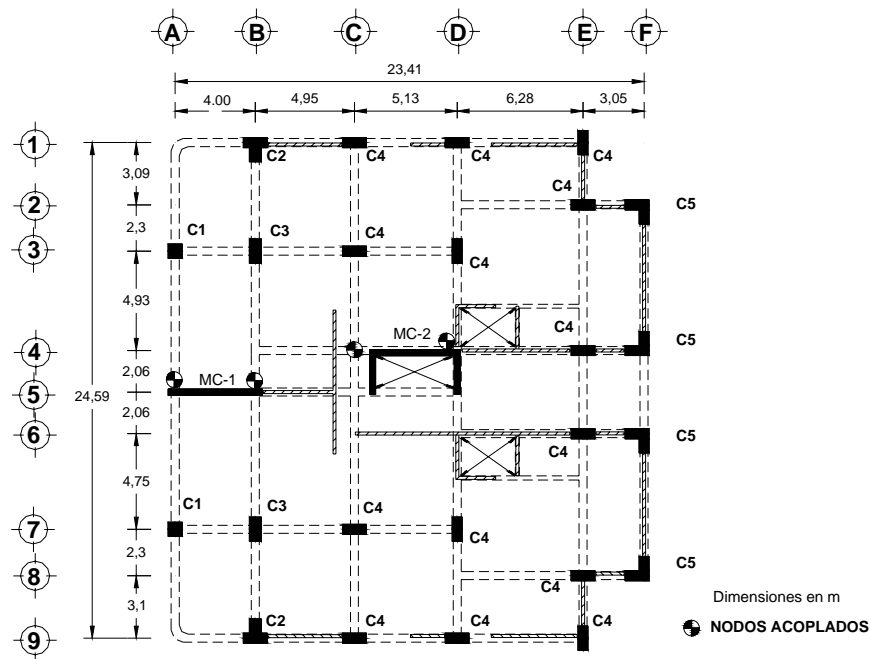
Vista en planta de los nodos acoplados en los niveles N1-N16, para el modelo plano de la dirección T
